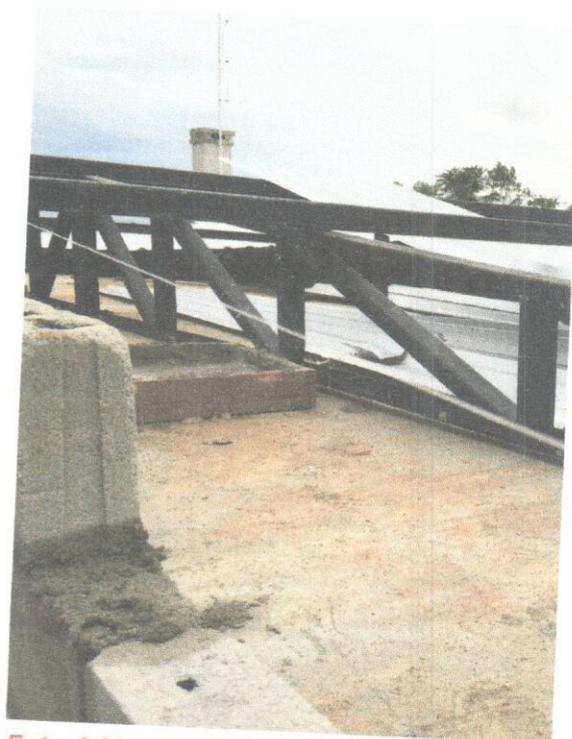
Vista da tesoura e das terças da estrutura metálica da cobertura.
